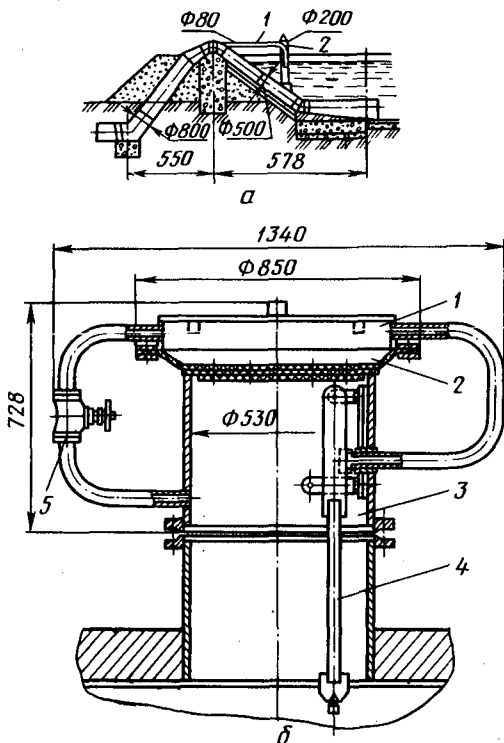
Клапан срыва вакуума в сифоне: а — гидравлический; 1 — трубка; 2 — металлический стакан; б — типа КСВМ-500Г: 1 — крышка клапана; 2 — мембрана; 3 — каркас клапана; 4 — рычаг гидравлического датчика; 5 — кран ручного дублера
